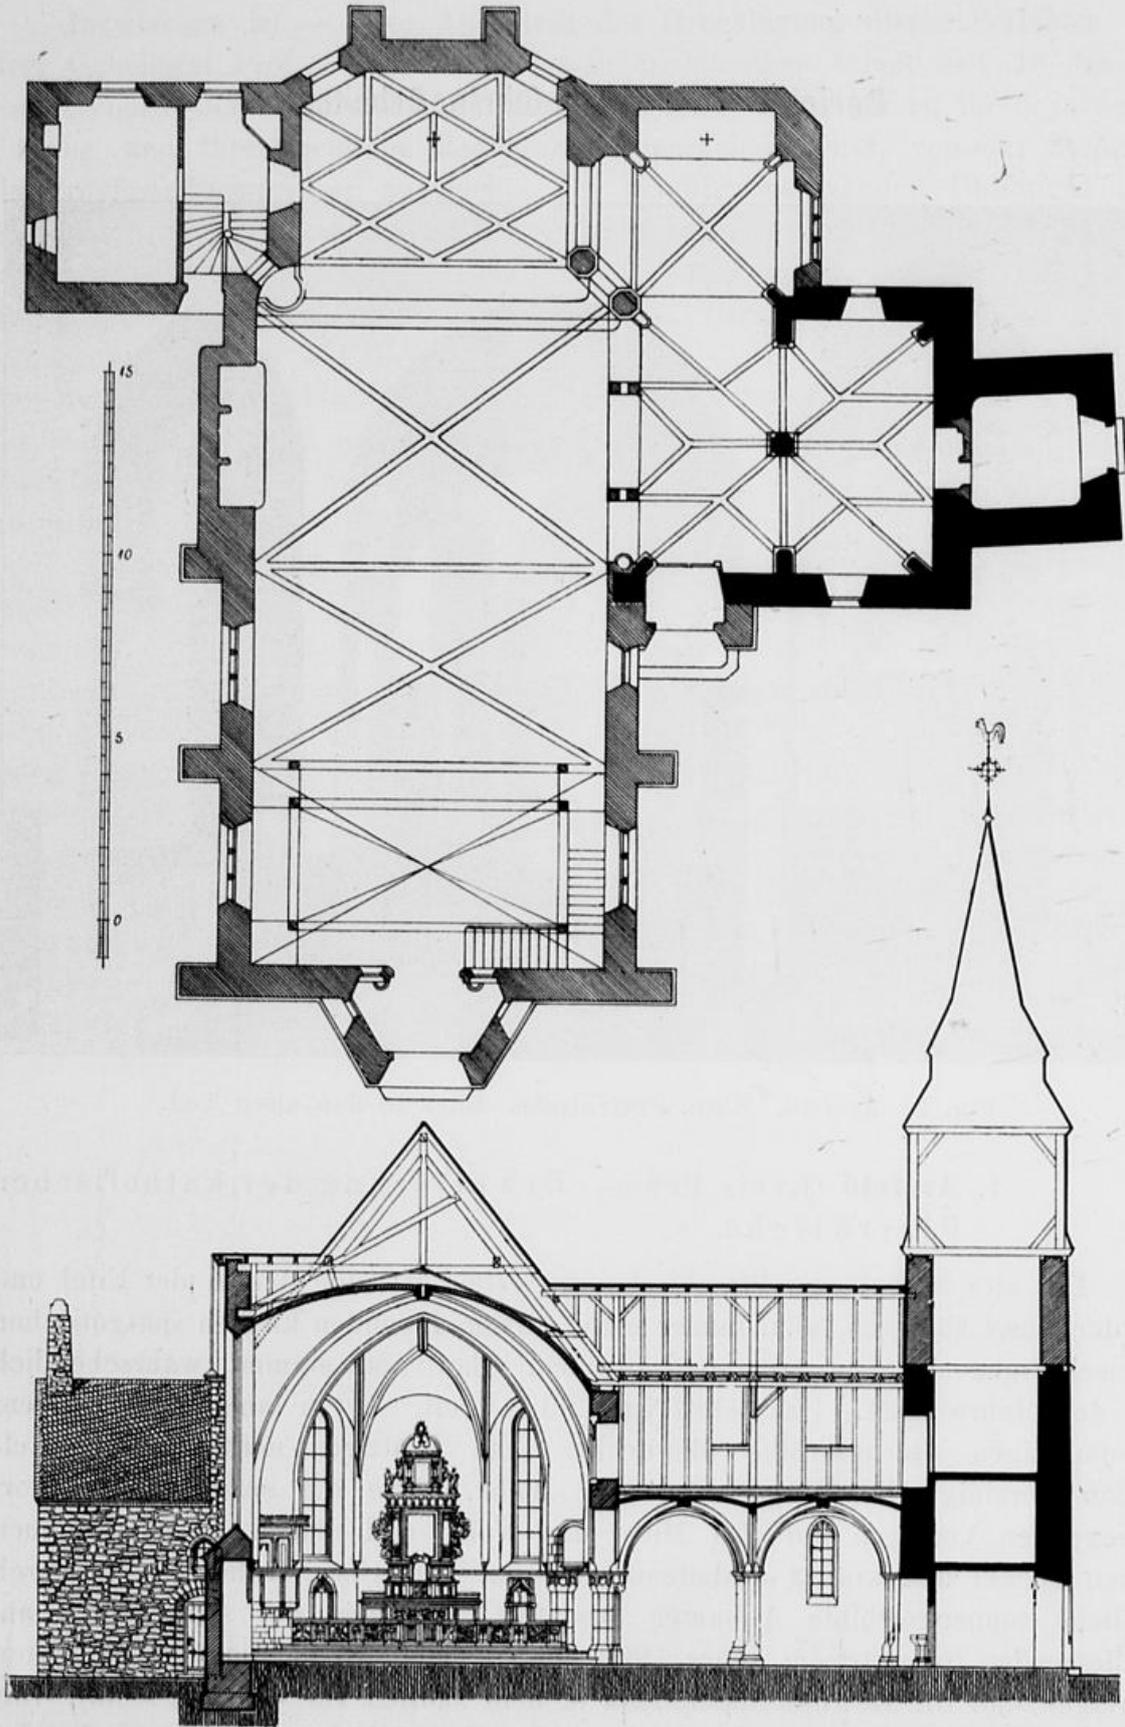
Arzfeld. Kath. Pfarrkirche. Grundriss und Querschnitt.
